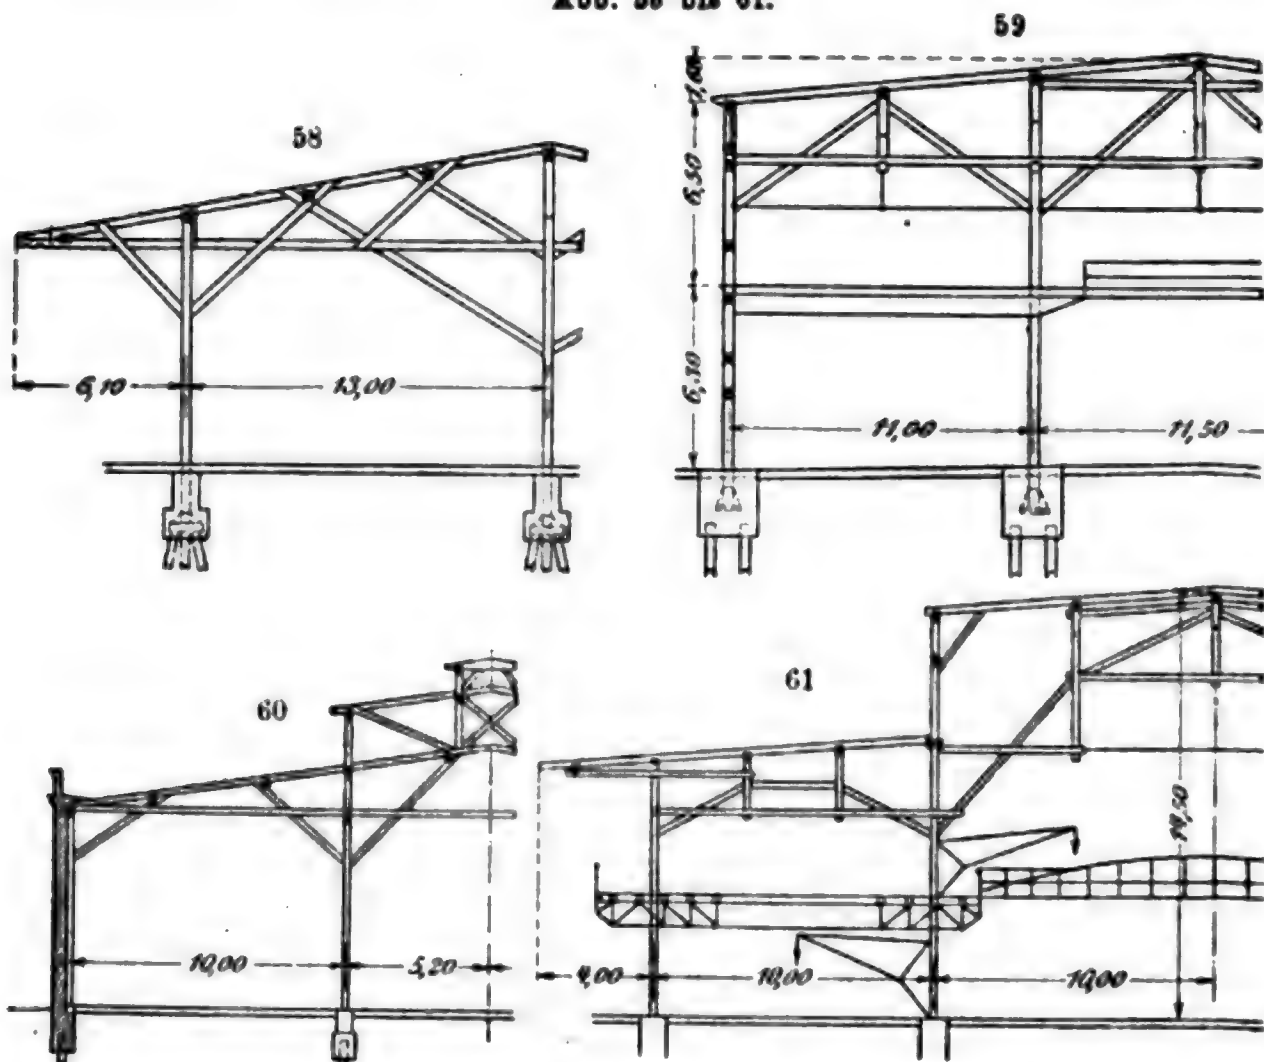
S. 308. Dreischiffige Lade- bzw. Fabrikhalle mit Zwischendecken in den Seitenhallen und Laufkran in der Mittelhalle. Eiserne Spannstrangen bei den Sprengwerken. Stielfuß ähnlich wie vor.
